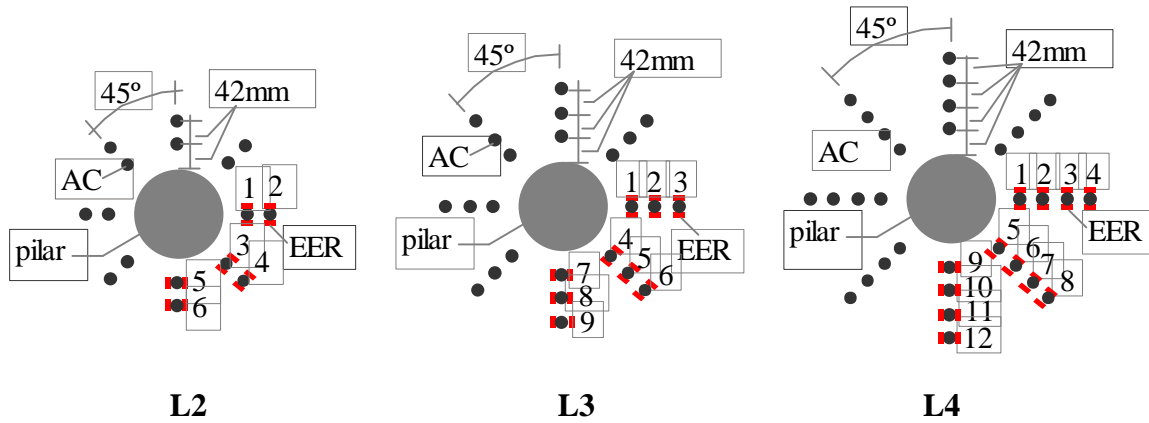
Posição e numeração dos EER nas armaduras de punção das lajes do Grupo 1
